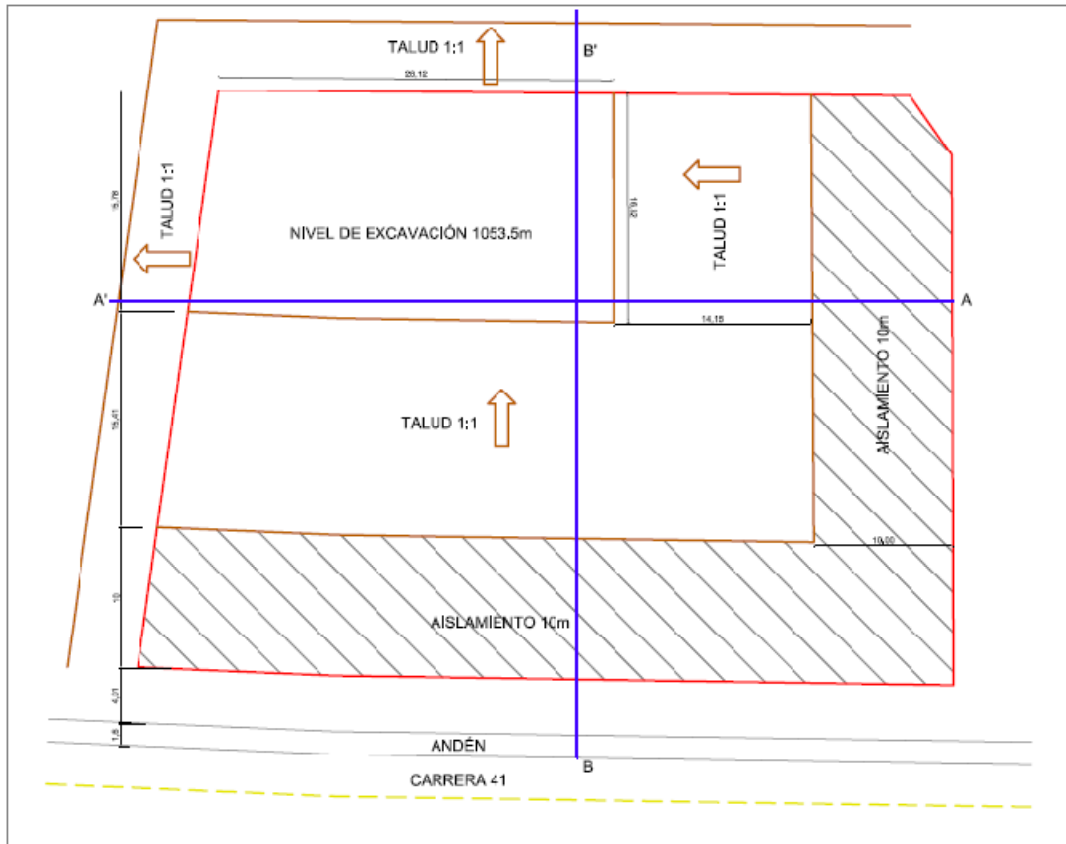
Paso 1.1: Detalle del corte longitudinal y transversal del lote, se observan las características de la excavación antes de comenzar la construcción de la pantalla.
